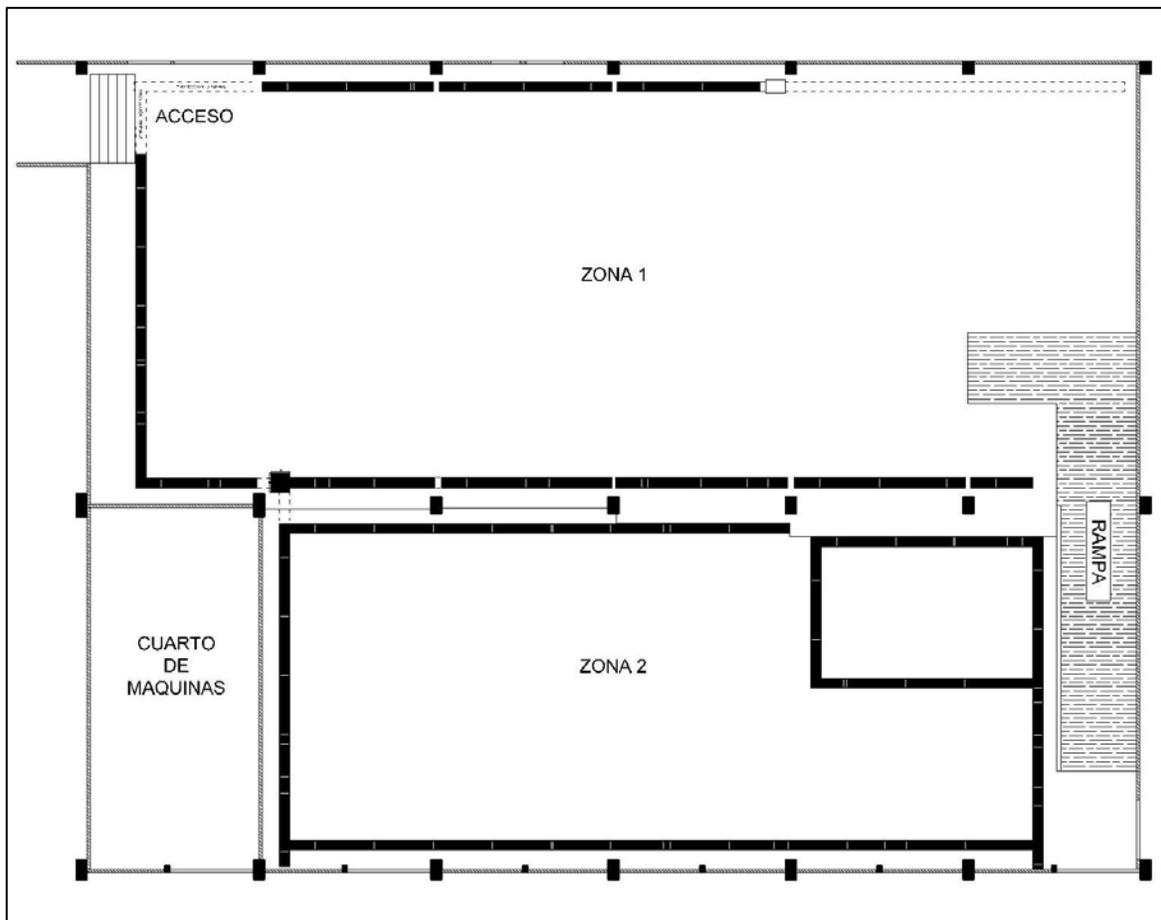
Plano del Sistema de Drenaje de la Planta Piloto de la UNAM FES Zaragoza
